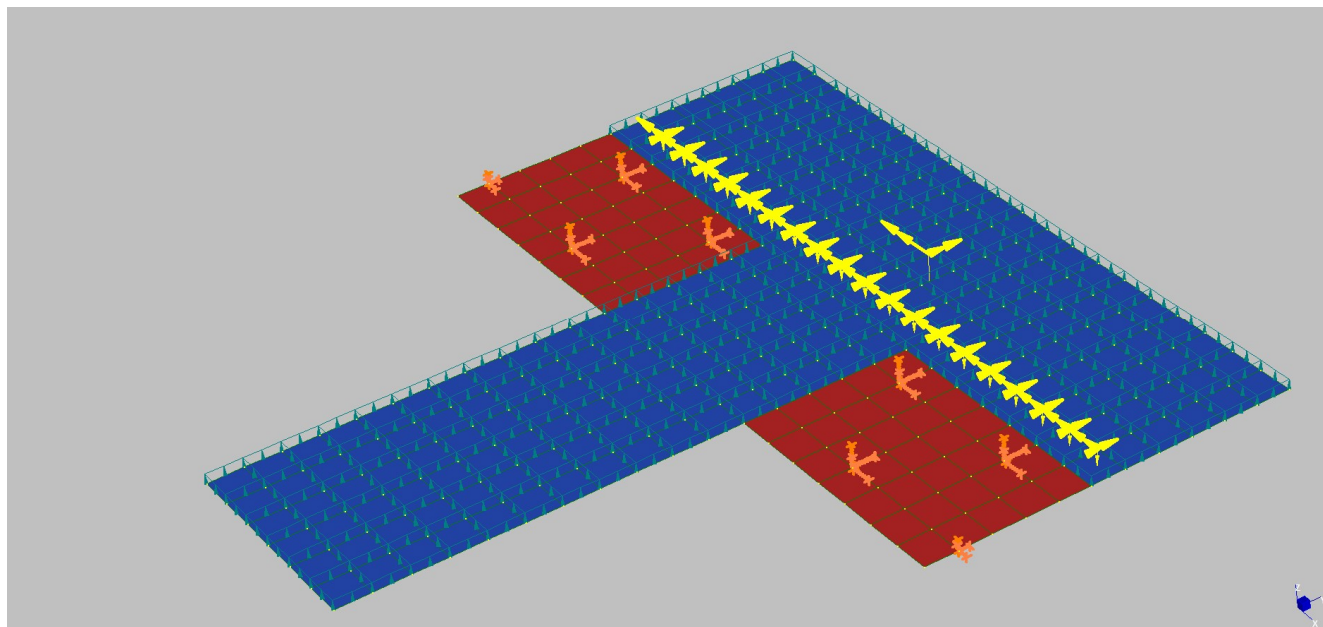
vista del modello di calcolo strauss per fondazione mista zona Arancio.
